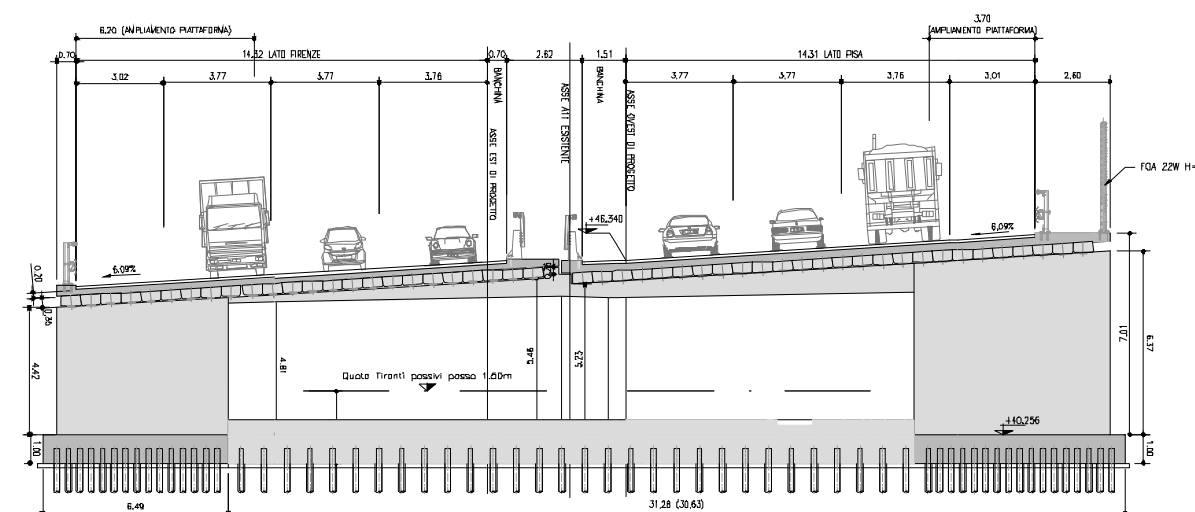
Sottovia via Campestre. Sezione trasversale
